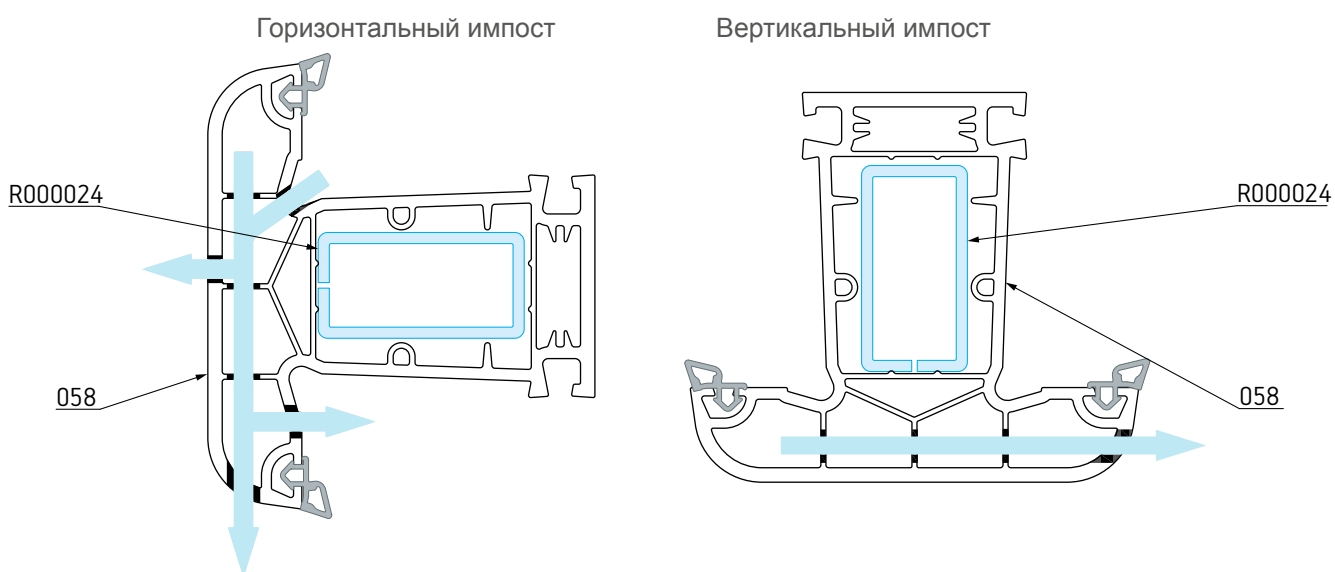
Типовые схемы вентиляции предкамеры для цветных профилей
